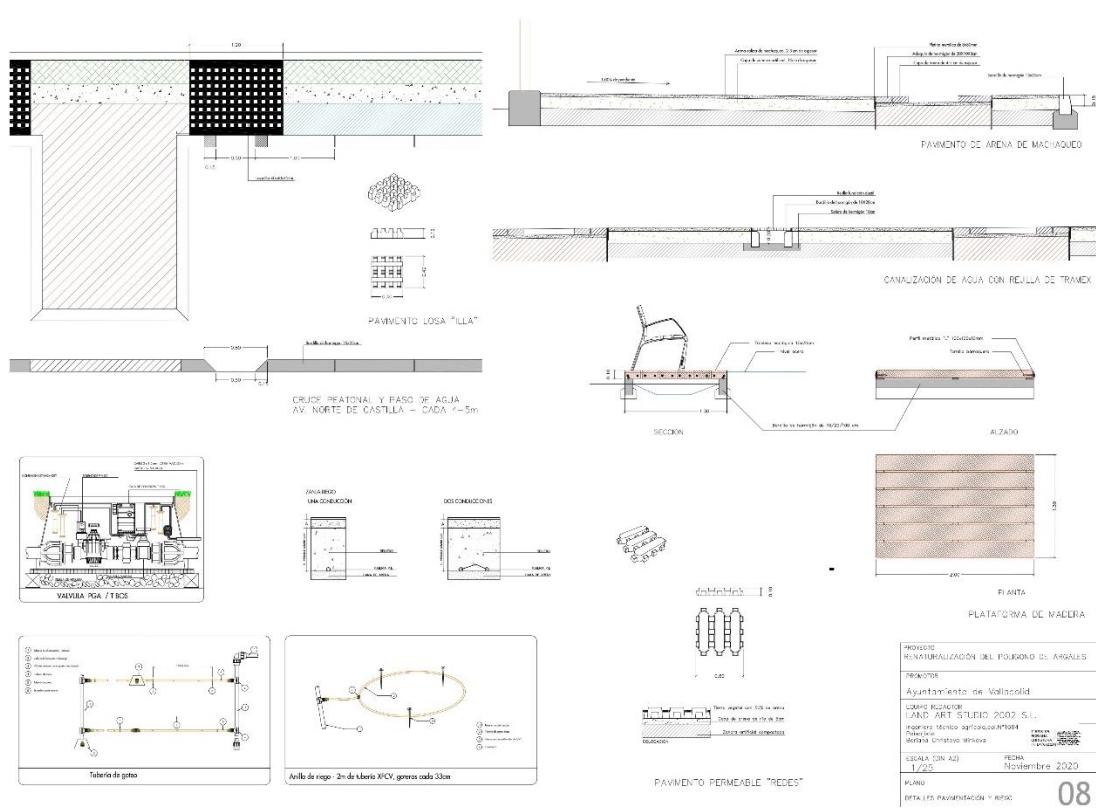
Detalles de pavimentación. Fuente: Land Art Studio 2000 S.L.
